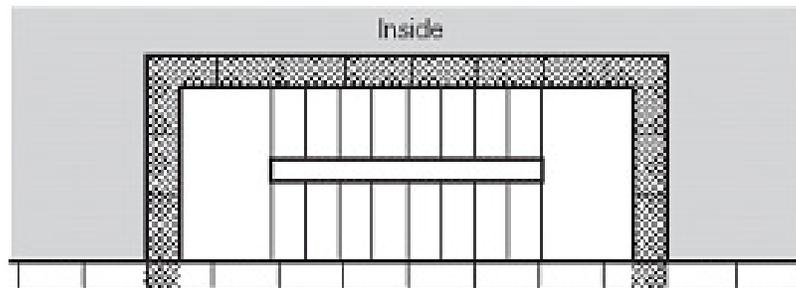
CAJA ESCALERA CON UN MURO EXTERIOR
